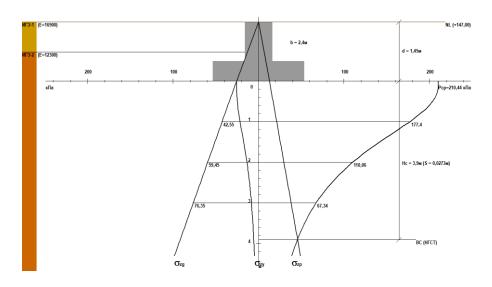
Расчетная схема к расчету осадки фундамента по оси «А» Таблица 2.3.3.1 - Расчет осадок в элементарных слоях (фундамент по оси А)
